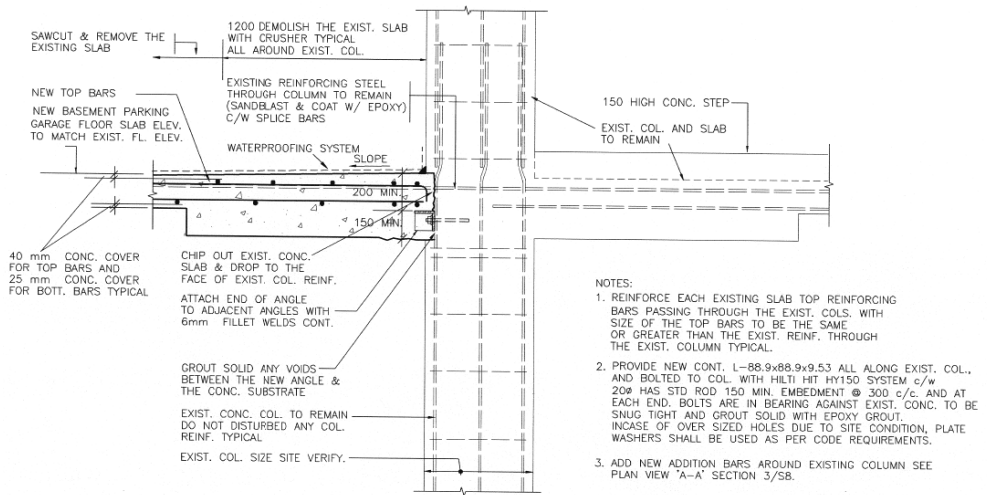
Imbinarea noului planșeu din beton armat cu stâlpul existent - secțiune tipică (reabilitare parțială)
